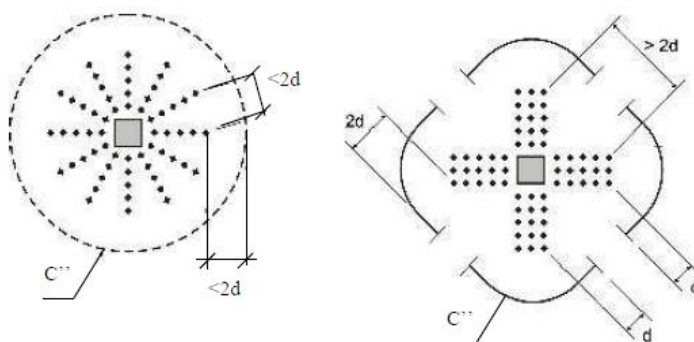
Disposição da armadura de punção em planta (LONGO, 2012).
